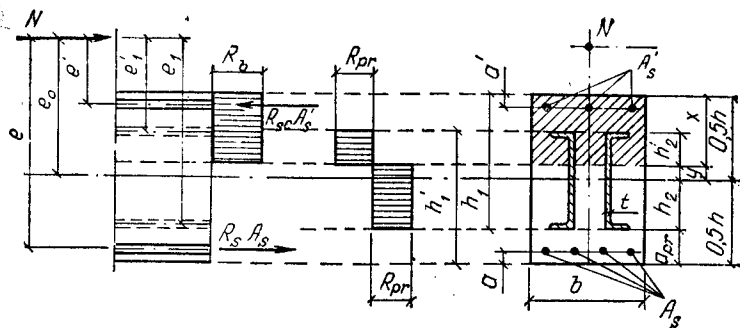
К расчету внецентренно сжатых элементов с жесткой арматурой; стенки стального профиля пересечены границей сжатой зоны
